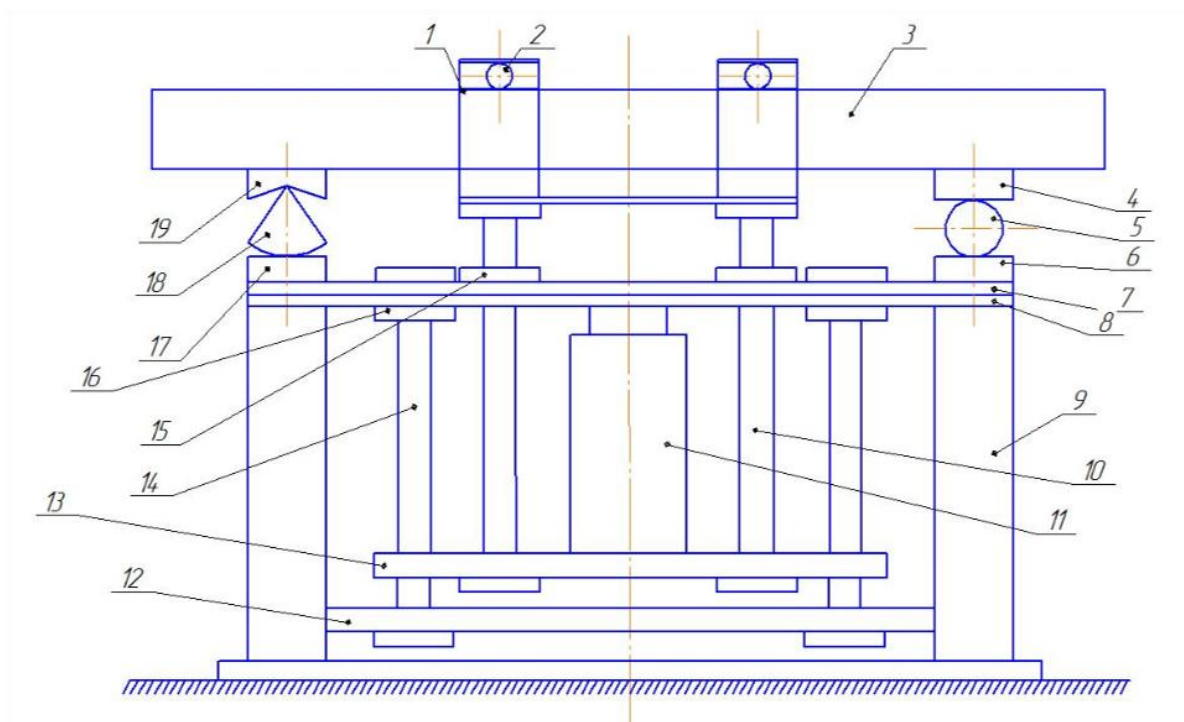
Схема стенда для испытания балочных элементов:
